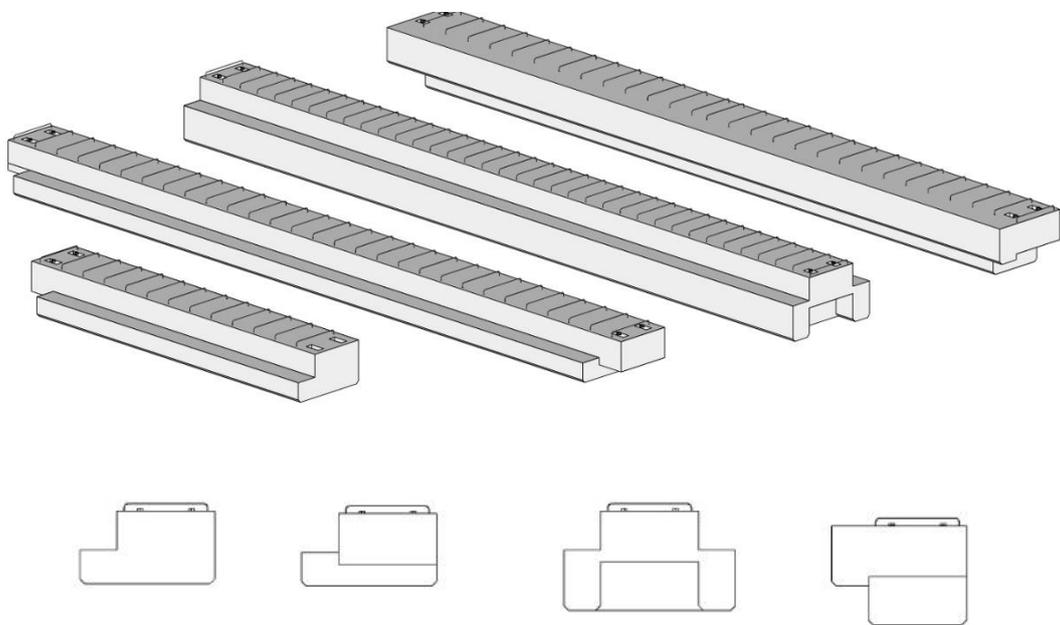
Vigas L y T invertida Fuente: Jaime Santa Cruz, SketchUp, TEMA (2024).
